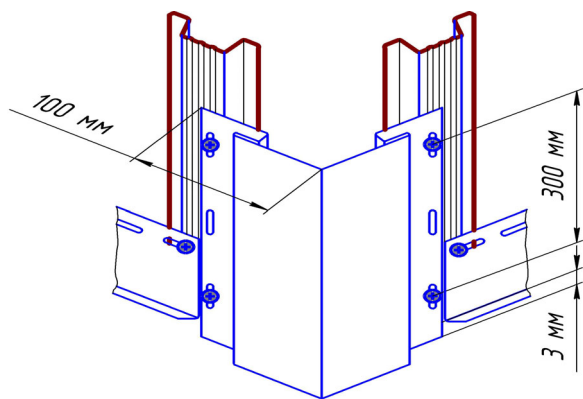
Крепление начальной планки ПОП1 и углового нащельника ПОН4-1
